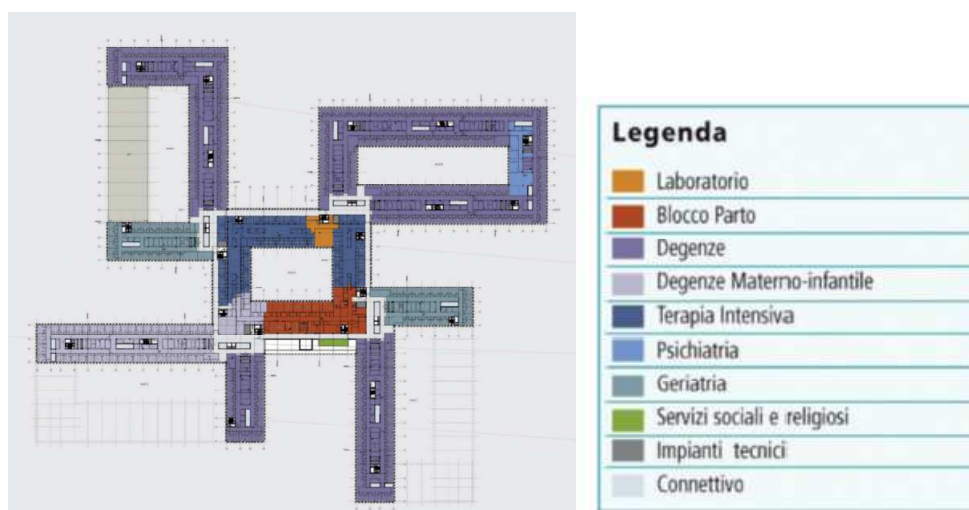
pianta del primo piano. (Fonte: Baumschlager-Eberle Architekturbüro e FDA Architecten & Ingenieurs).
